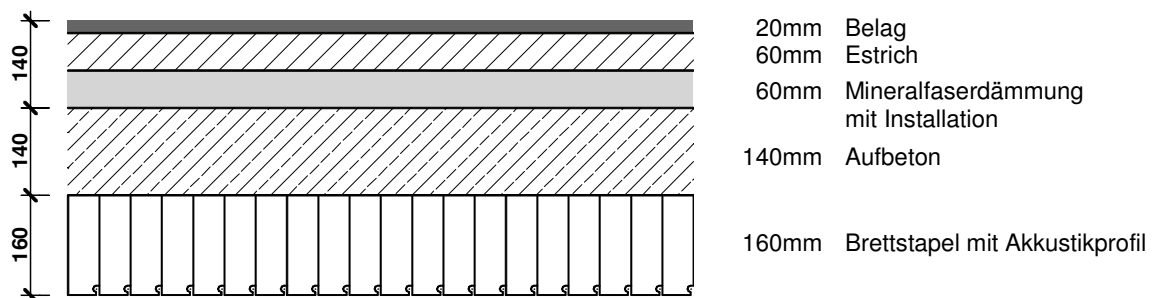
Deckenaufbau am Bsp. Hohenems [mkp]
